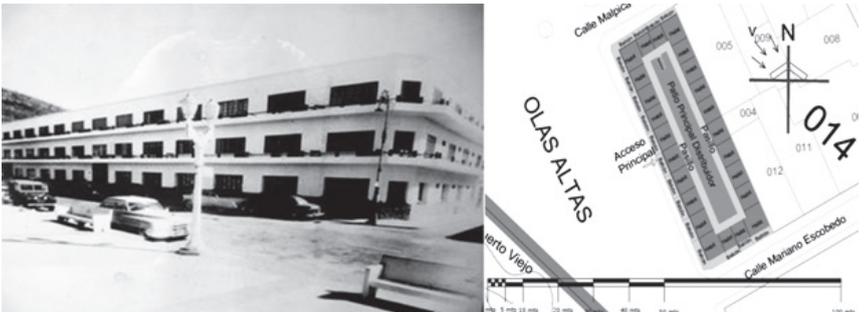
IZQUIERDA, VISTA EXTERIOR DEL HOTEL FREEMAN. DERECHA, PLANO ACTUAL
